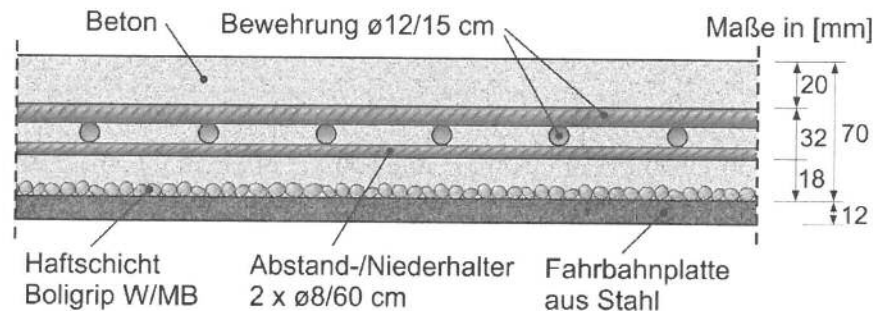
Schematische Darstellung des Aufbaus einer mit hochfestem Beton ertüchtigten orthotropen Fahrbahnplatte aus Stahl [15]
